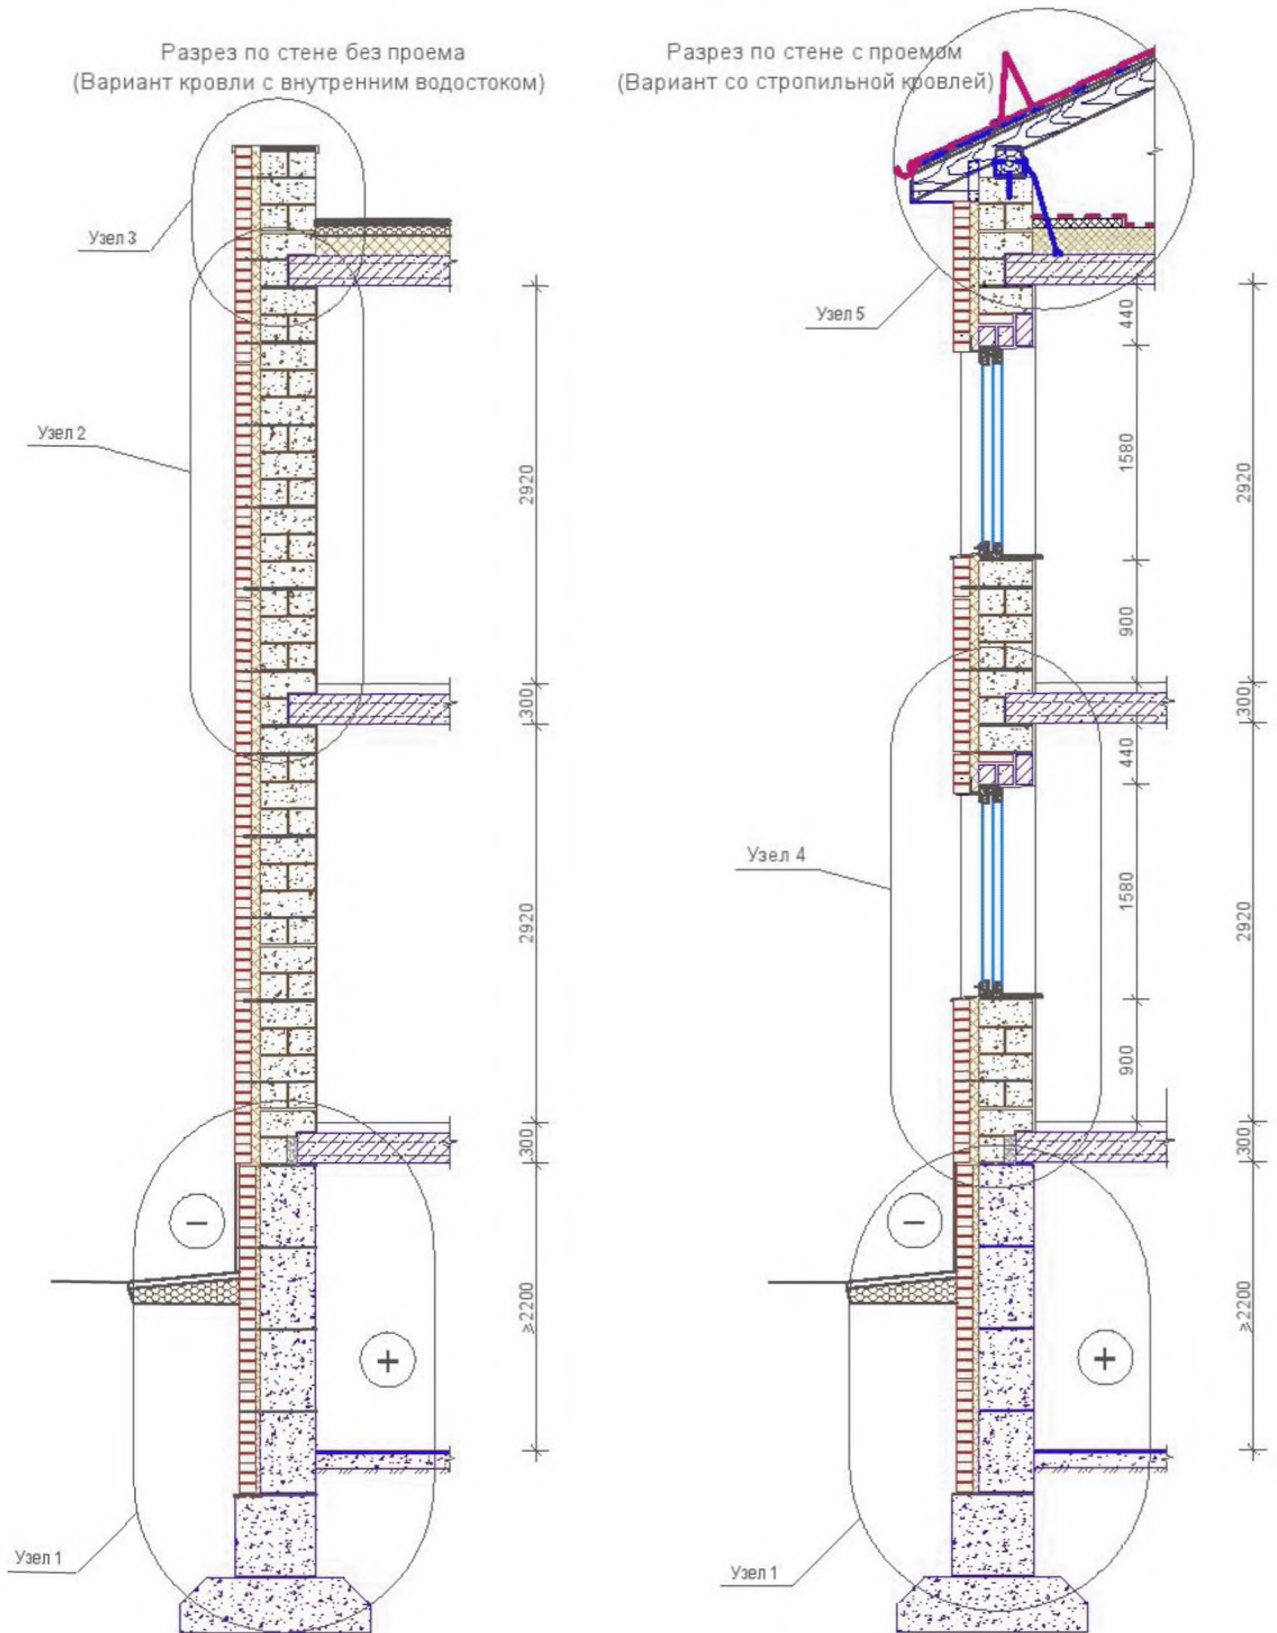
Схема нумерации узлов на поперечном разрезе здания (Стены со связью облицовочного слоя с основным металлическими сетками)
